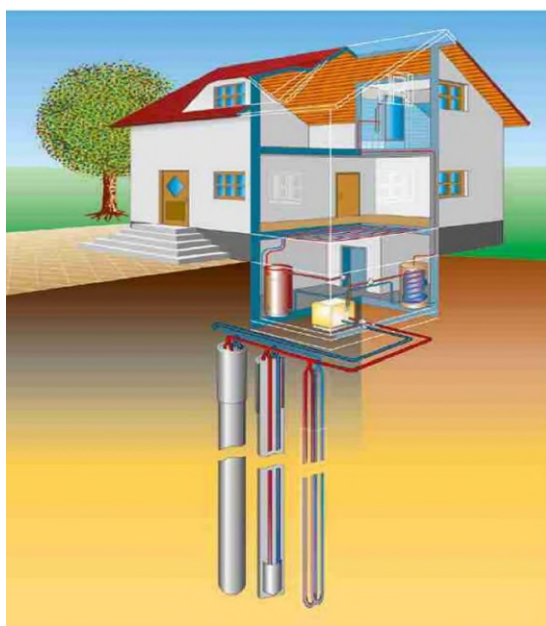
Schema einer Wärmepumpe mit Erdwärmesonde
